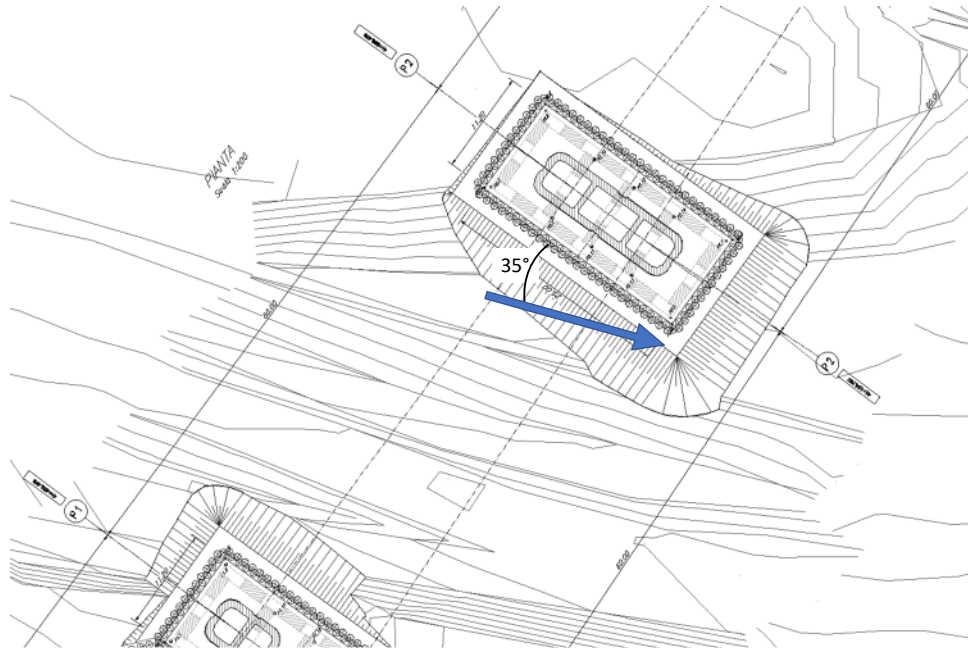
Pianta fondazione pila2 e direzione di corrente
